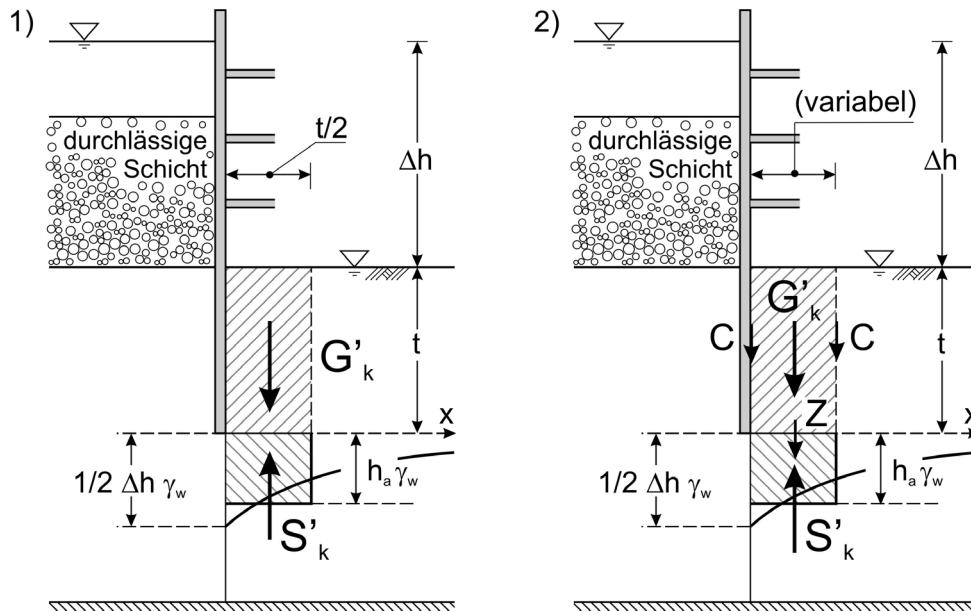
Berechnungsansätze für einen hydraulischen Grundbruch an einer umströmten Baugrubenwand: 1) für nichtbindigen Baugrund nach Terzaghi & Peck (1961), 2) für bindigen Baugrund nach Davidenkoff (1964)
